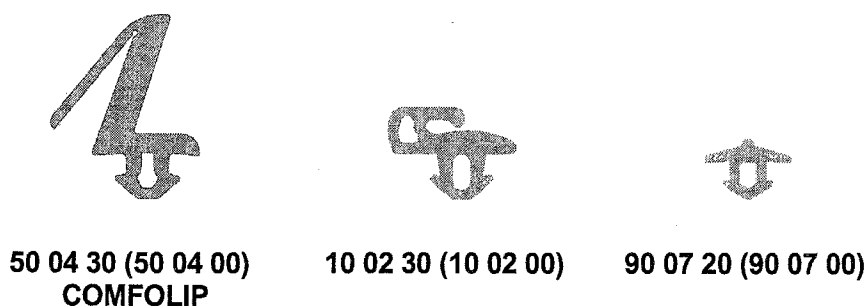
Przekroje uszcelek osadczych zewnętrznych do szyb o grubości 24 mm
